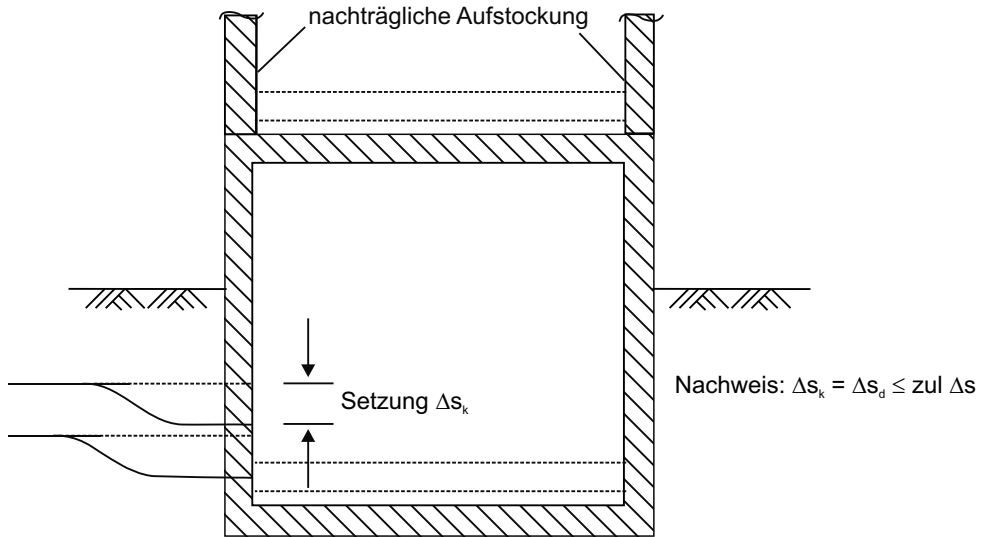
Nachweis der Gebrauchstauglichkeit am Beispiel der Zerstörung einer Hausanschlussleitung durch zu große Setzungen infolge Aufstockung des Gebäudes
